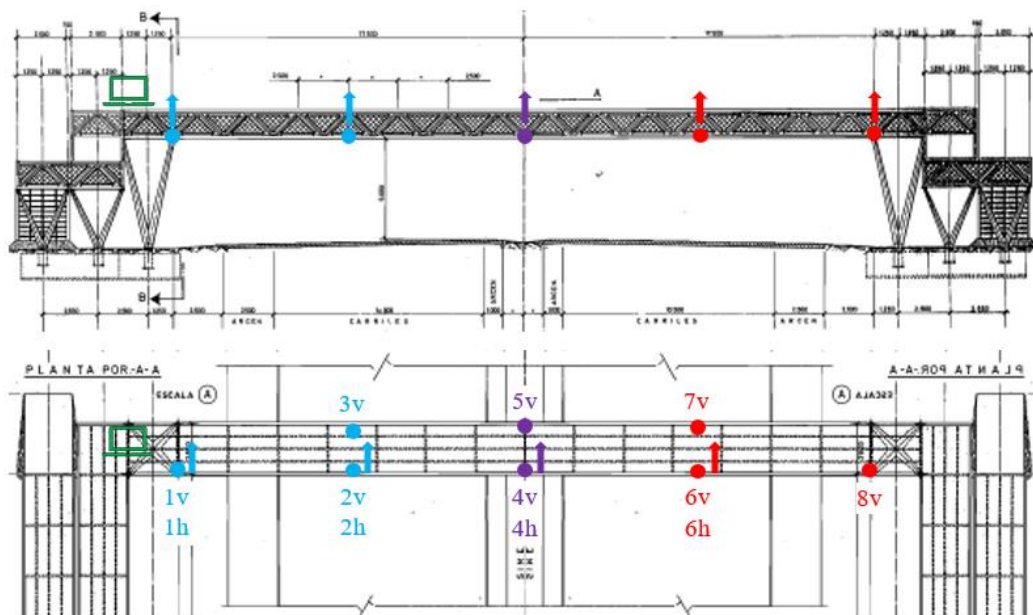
Vista en alzado y planta de la pasarela con la disposición de los acelerómetros con su dirección de medición
